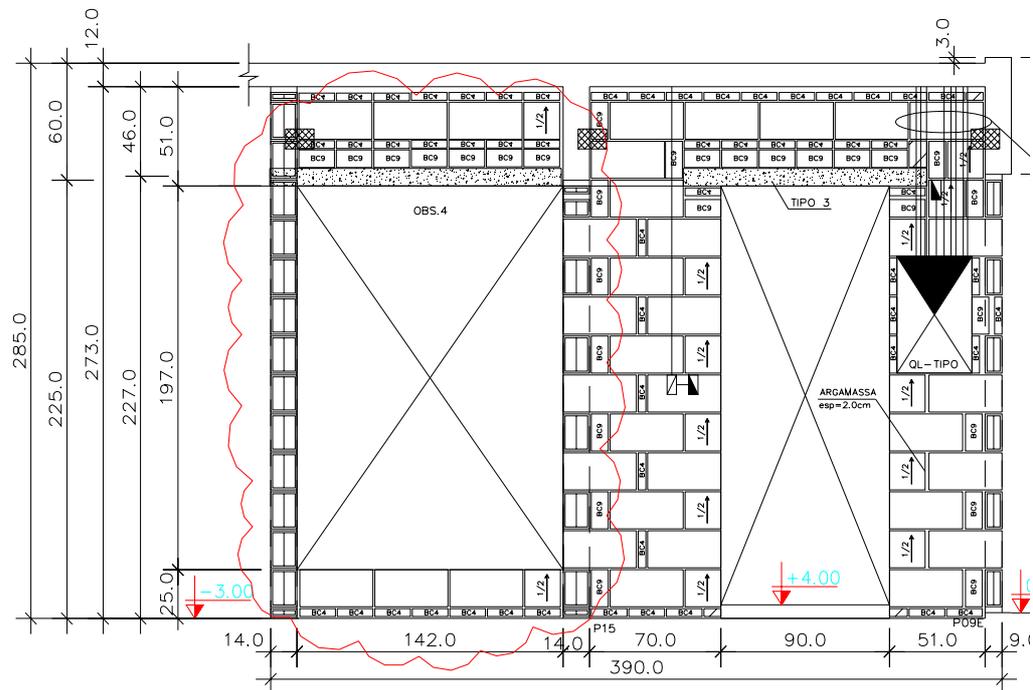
Elevação da parede na região central da escada revisada pelo projeto de vedação para o 9º ao 17º pavimento.
